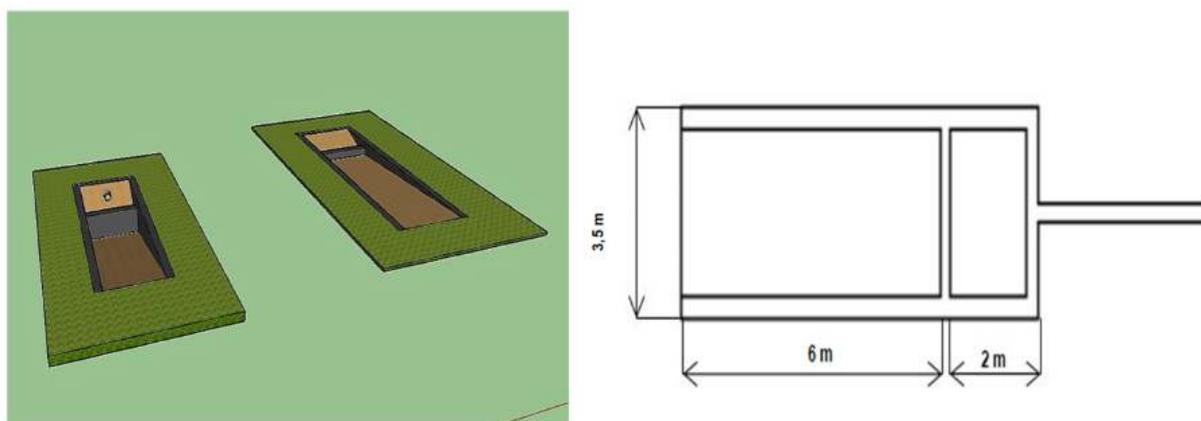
Boceto de diseño anteproyecto de pileta de lavado. (Foto cortesía archivo de la empresa Vecchio SRL)
